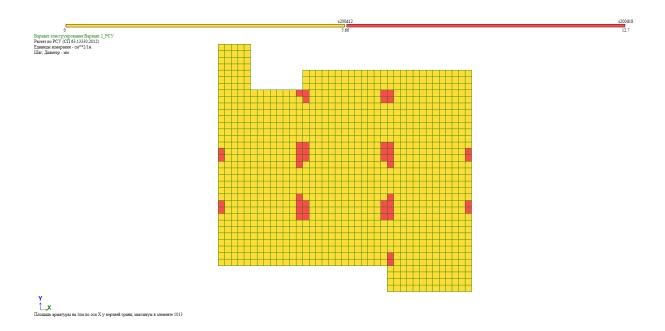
Армирование плиты оси X (верхняя зона)
